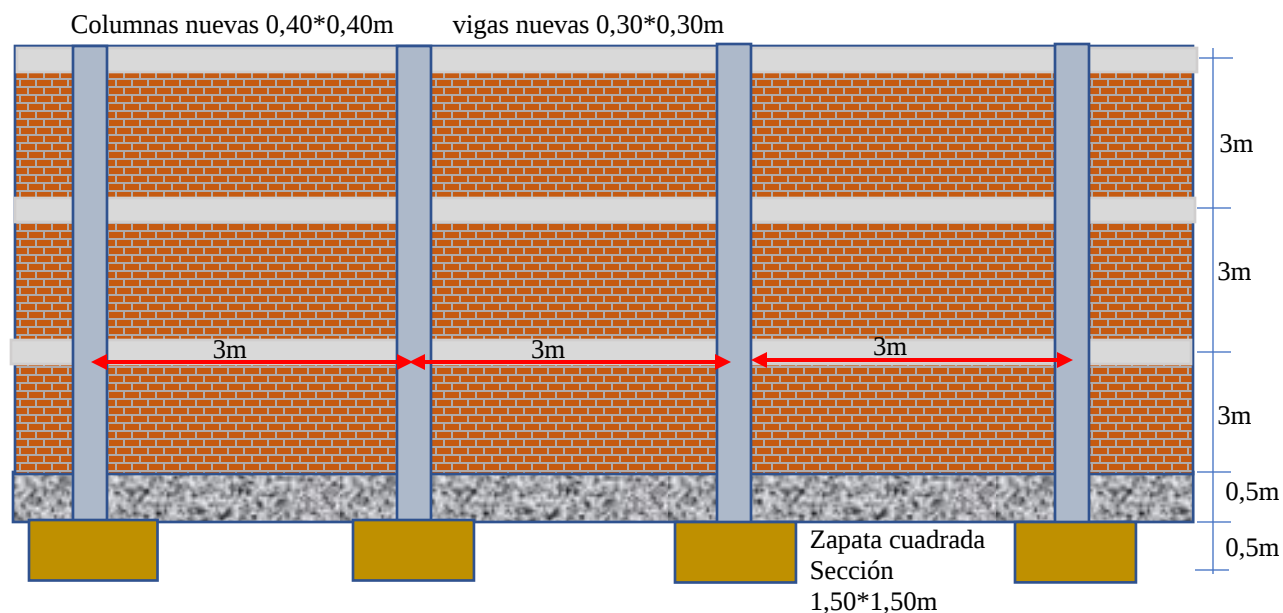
Propuesta #1 de intervención muro mampostería exterior aparcamiento y zapata
